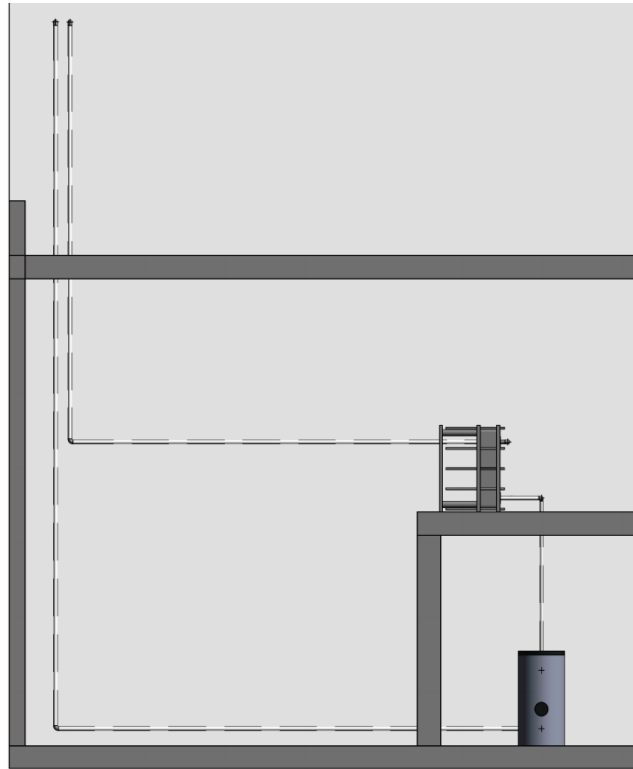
Corte da área técnica com tubagem de água gelada para frigidifusores.
